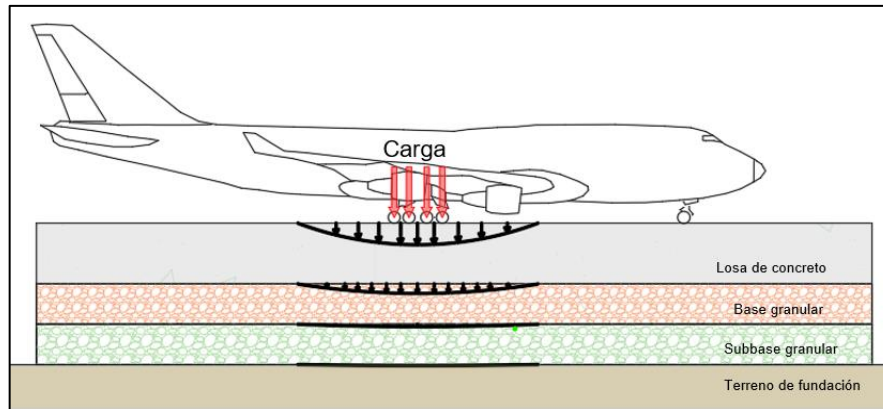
Esquema general de un pavimento de concreto hidráulico.
